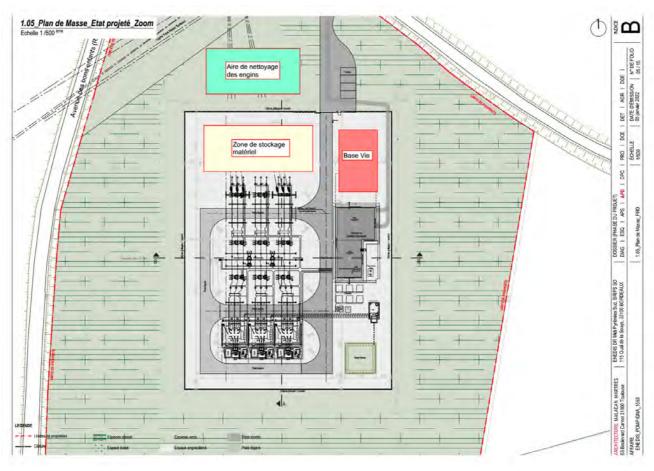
Plan de masse localisant les installations du chantier (source : Malacan Martres)
